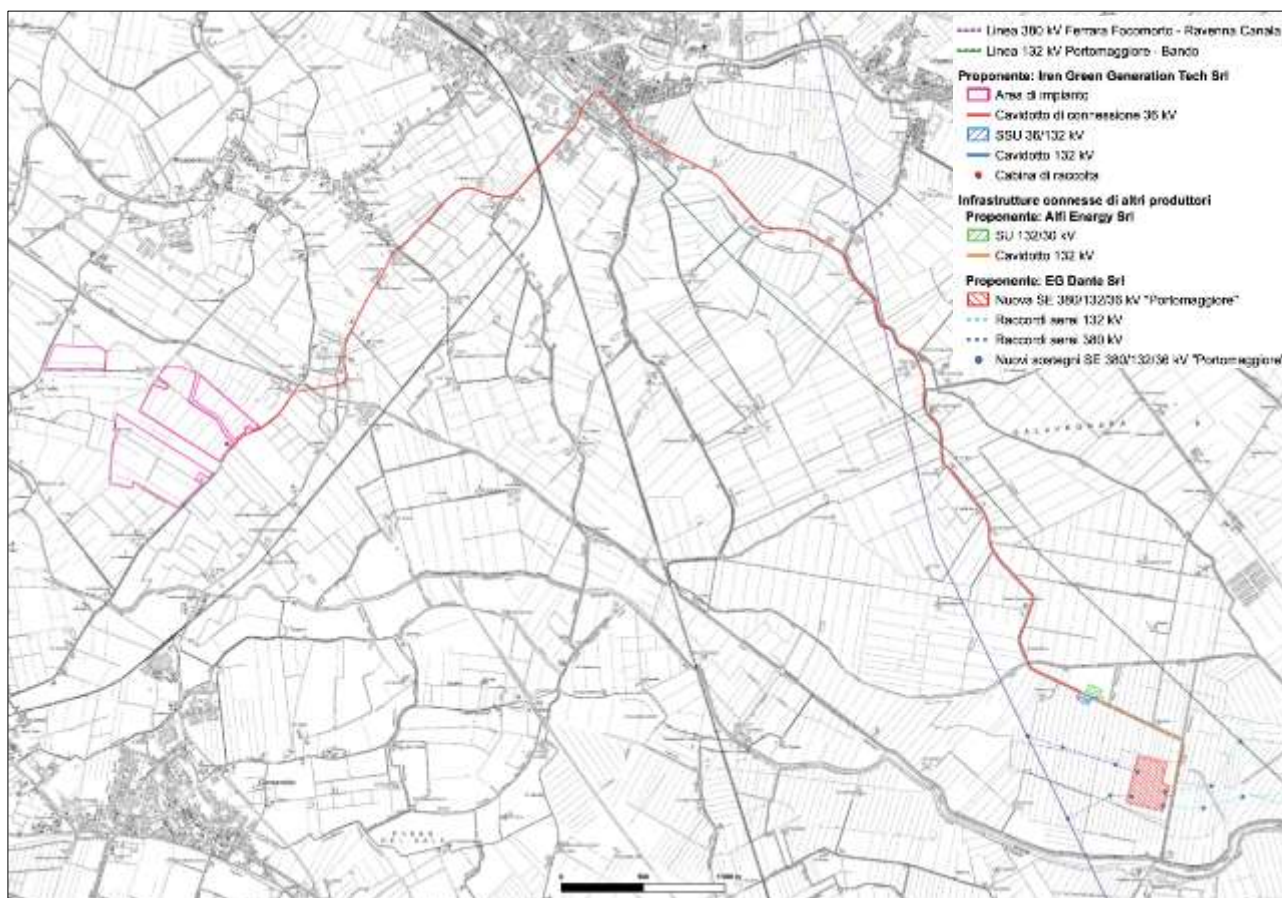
Planimetria con individuazione dell'area di impianto e delle relative opere di connessione
